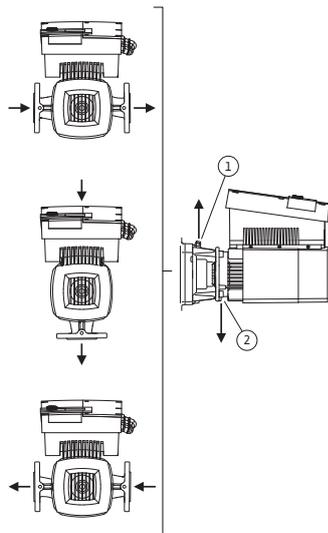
Zulässige Einbaulagen mit horizontaler Motorwelle
